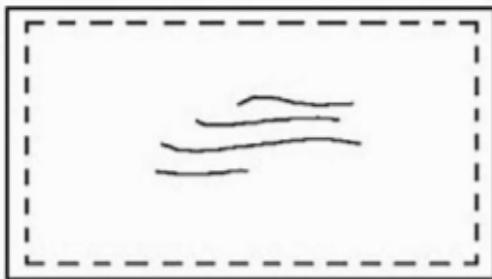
Fissuração por esmagamento do concreto, devido à reduzida espessura da laje. As fissuras surgem na face superior, por deficiência diante dos momentos positivos.
